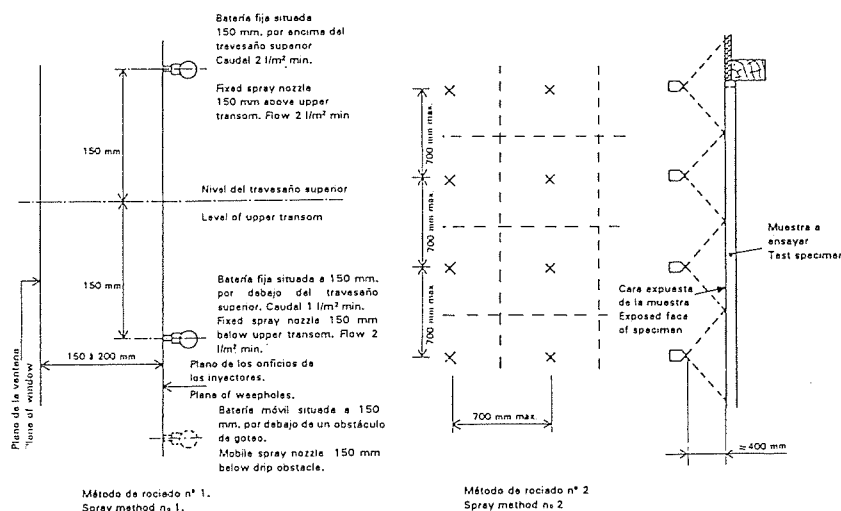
Disposición de las baterías de proyección. Figure 1. Layout of spray nozzles.
